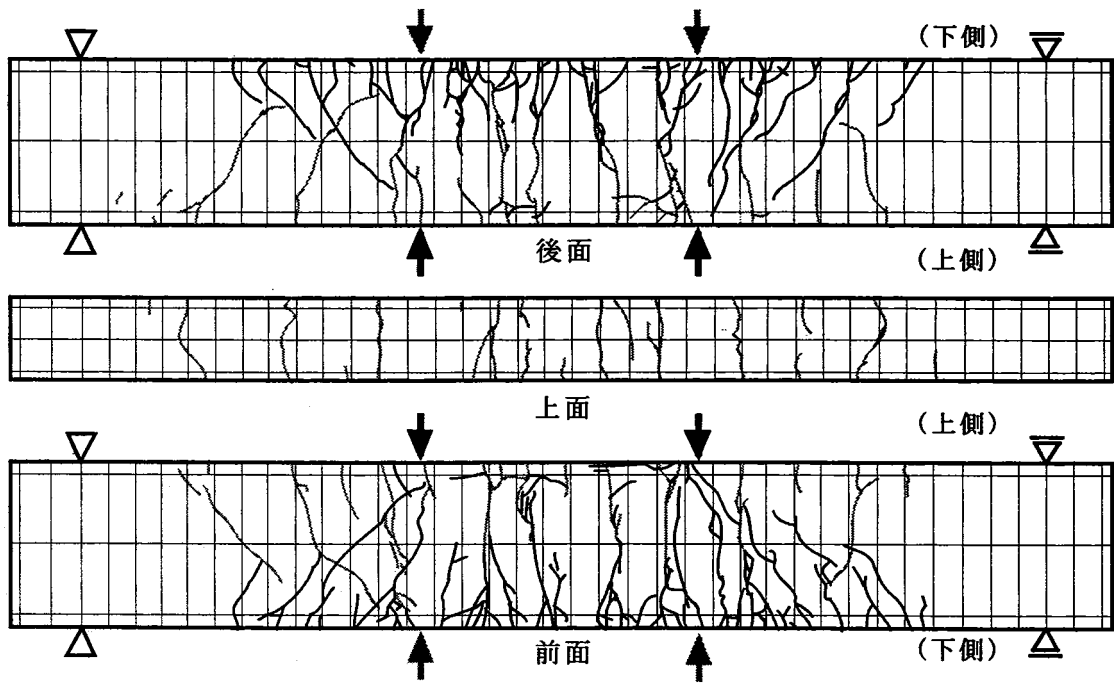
g) ひび割れ性状 [BS-3; 終局時]
